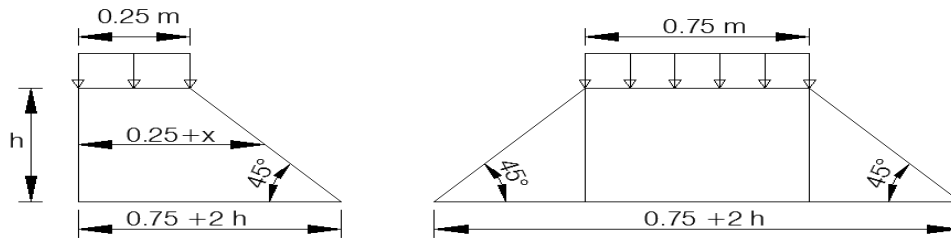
Poussée de la charge locale située en arrière du mur.
